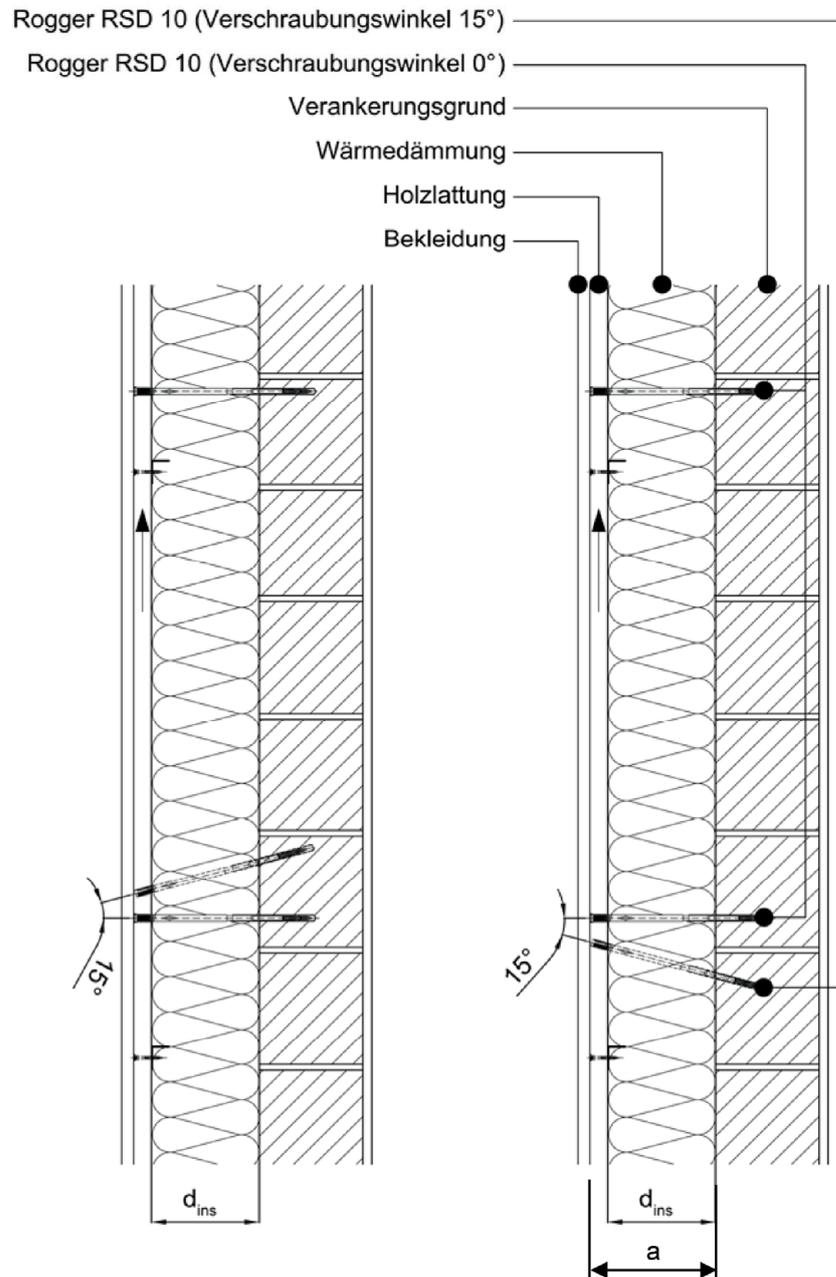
Fasadensystem mit einer Fassadeunterkonstruktion aus Holz (vorgehängte, hinterlüftete Fassade)
